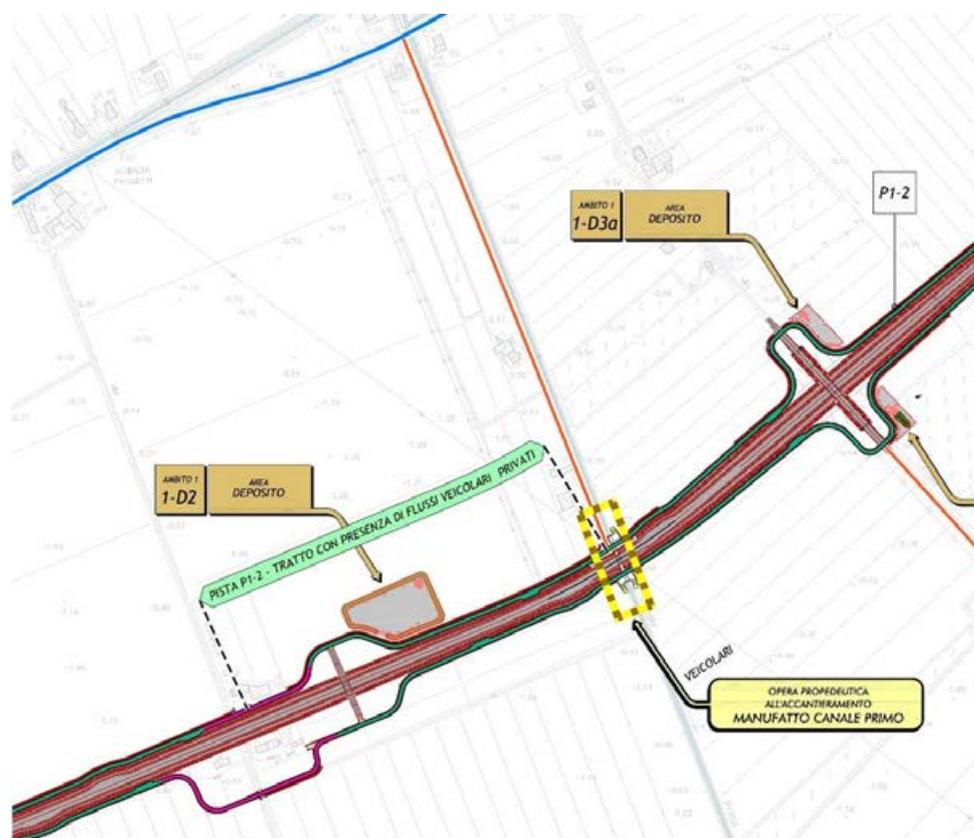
STRALCIO PLANIMETRICO DELLA PISTA P1-2 IN PROSSIMITÀ DEL RICETTORE 49A
